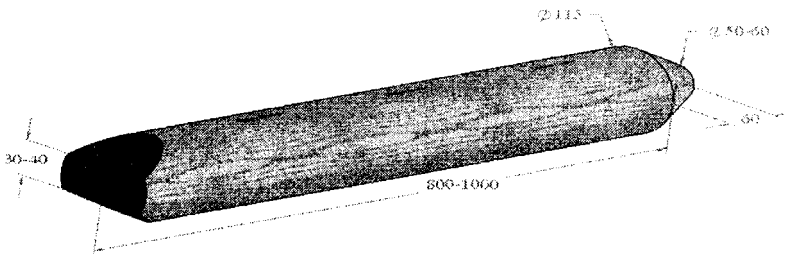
Деревянный податливый элемент распорно-податливой крепи
